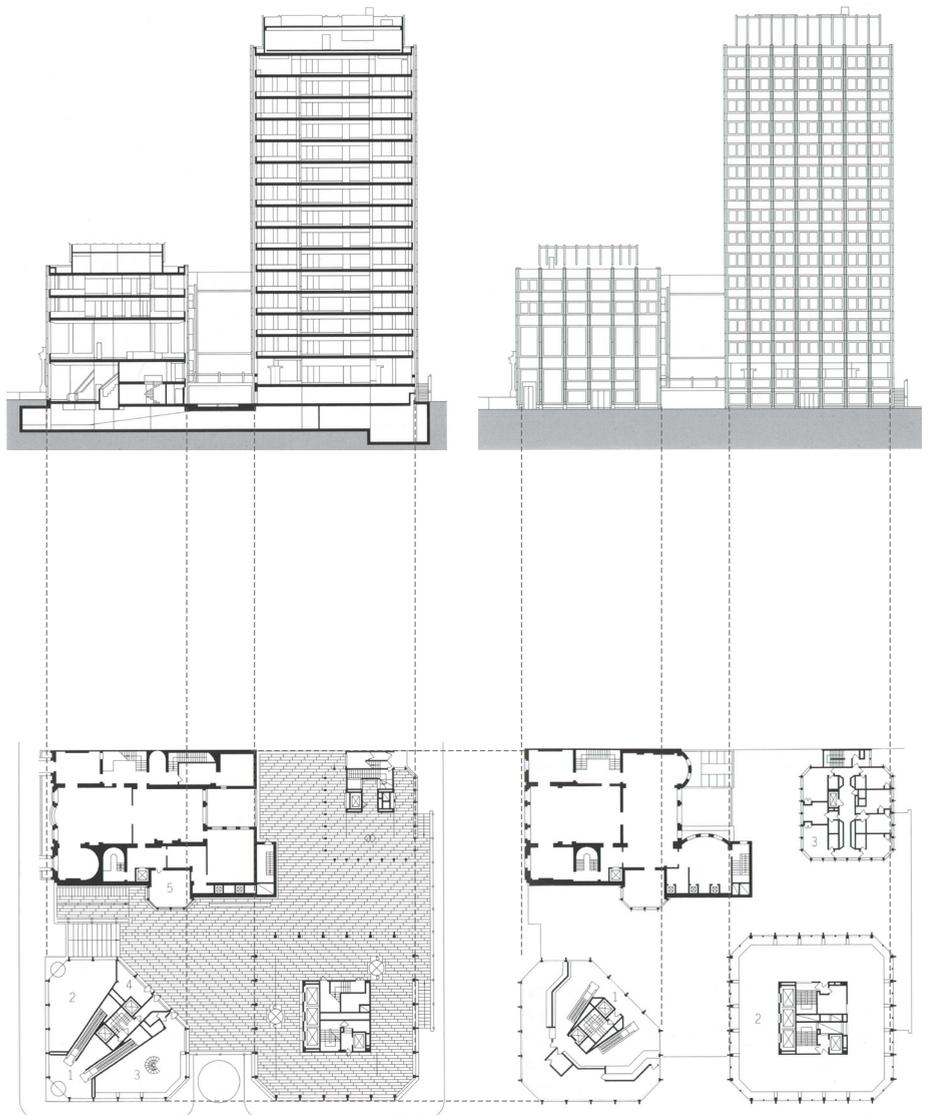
Planimetría básica del Economist Group: arriba sección tipo y alzado sureste a Ryder Street. Abajo planta cota +1.50 y planta tipo del conjunto.
